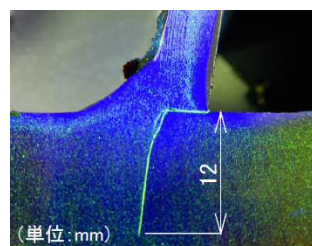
デッキプレート方向へのき裂 (供試体 B-3, F断面)
